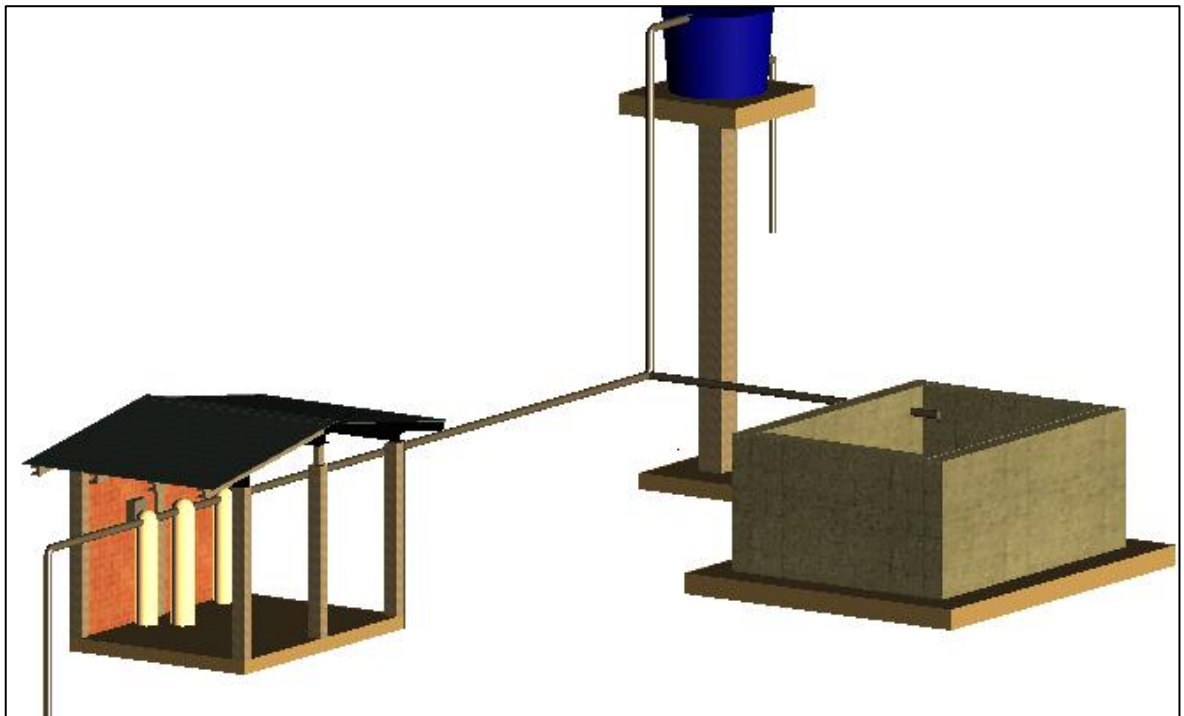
Modelado en 3D de la planta potabilizadora.
